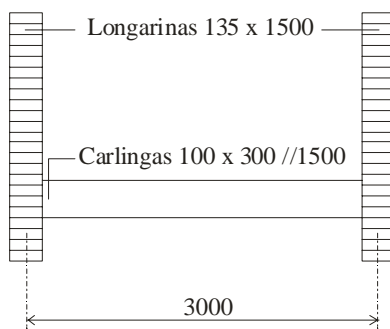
Secção transversal do tabuleiro simplesmente apoiado
